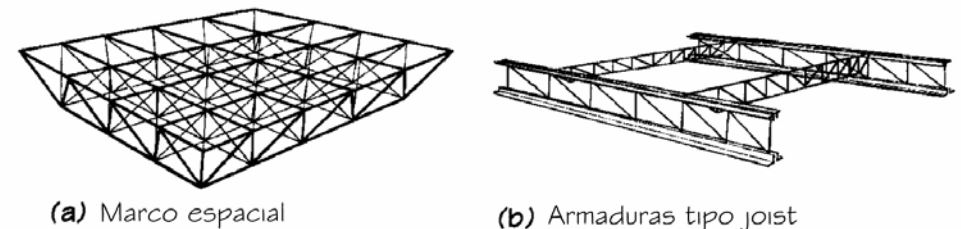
La profundidad de un reticulado espacial es menor si se compara con las armaduras planas.
